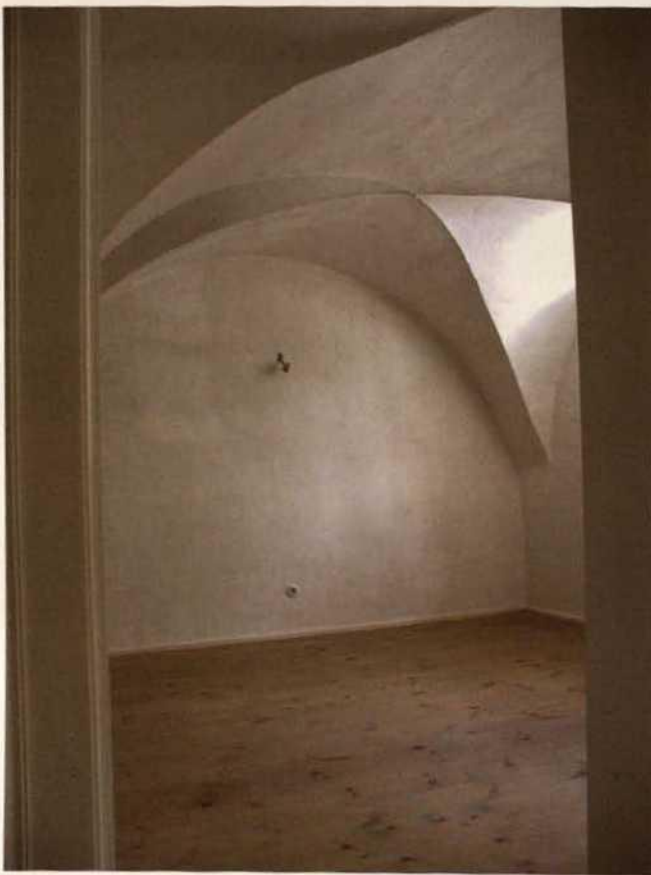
Kucha, Haus Nr. 18, Mühlengebäude, Erdgeschoss: gewölbte Kammer nach der Instandsetzung und Umnutzung zu Wohnzwecken (2003).
